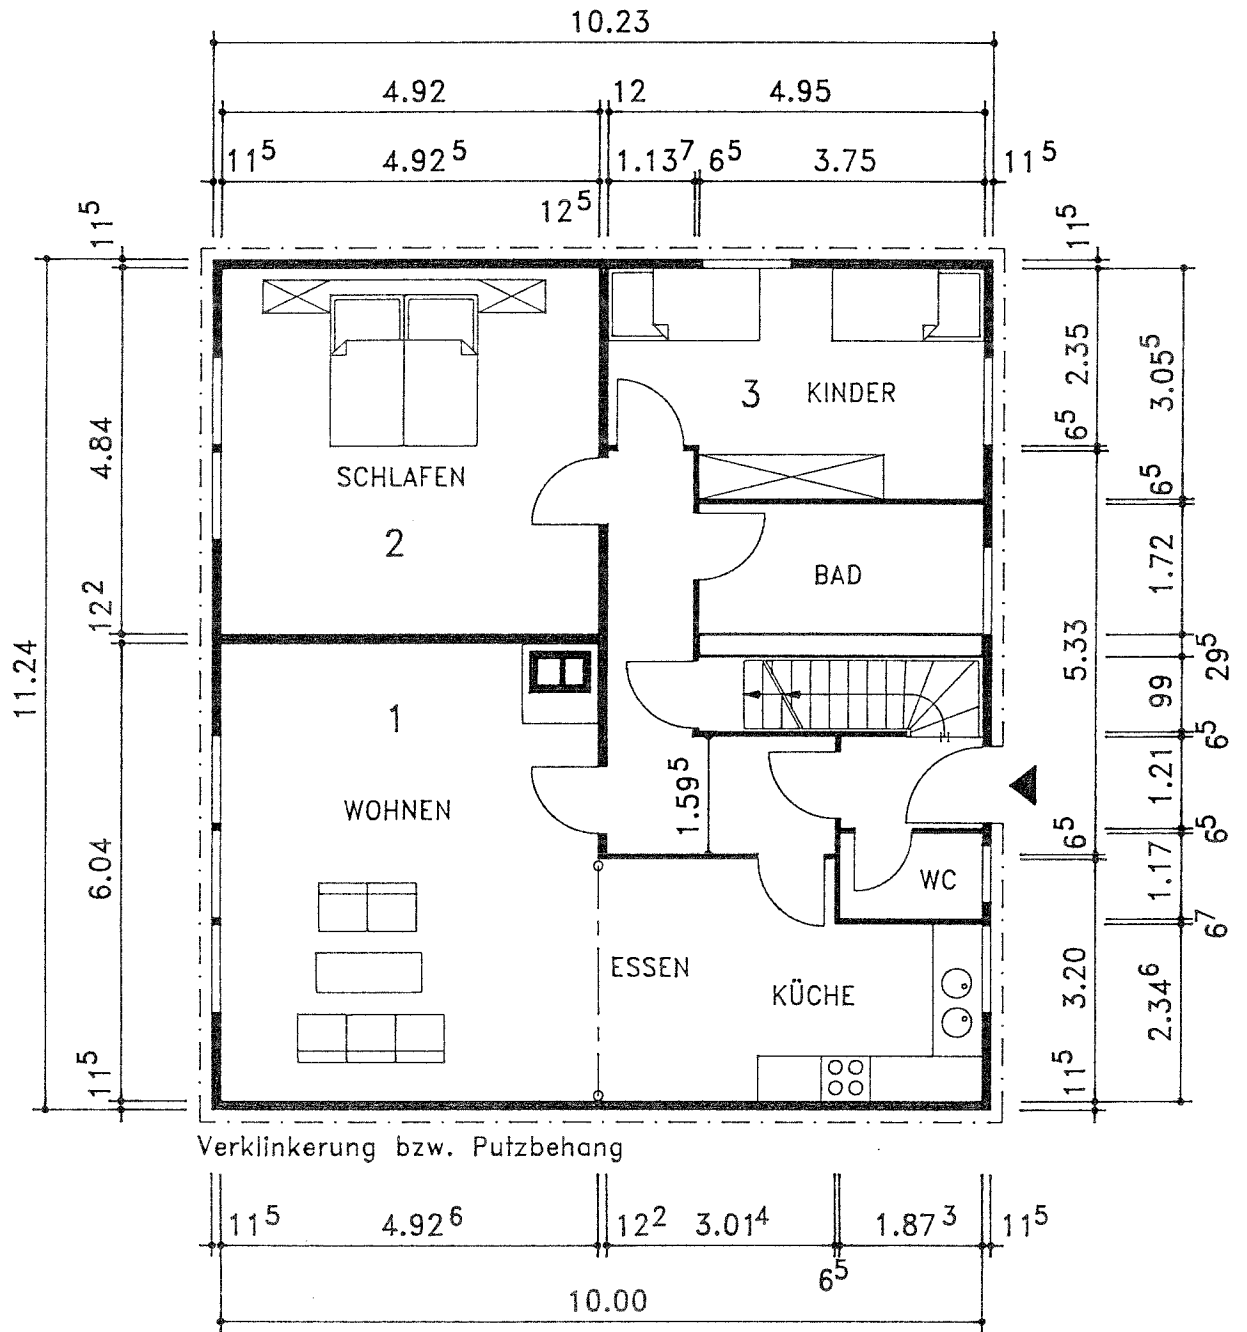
Erdgeschoßgrundriß des Fertighauses
